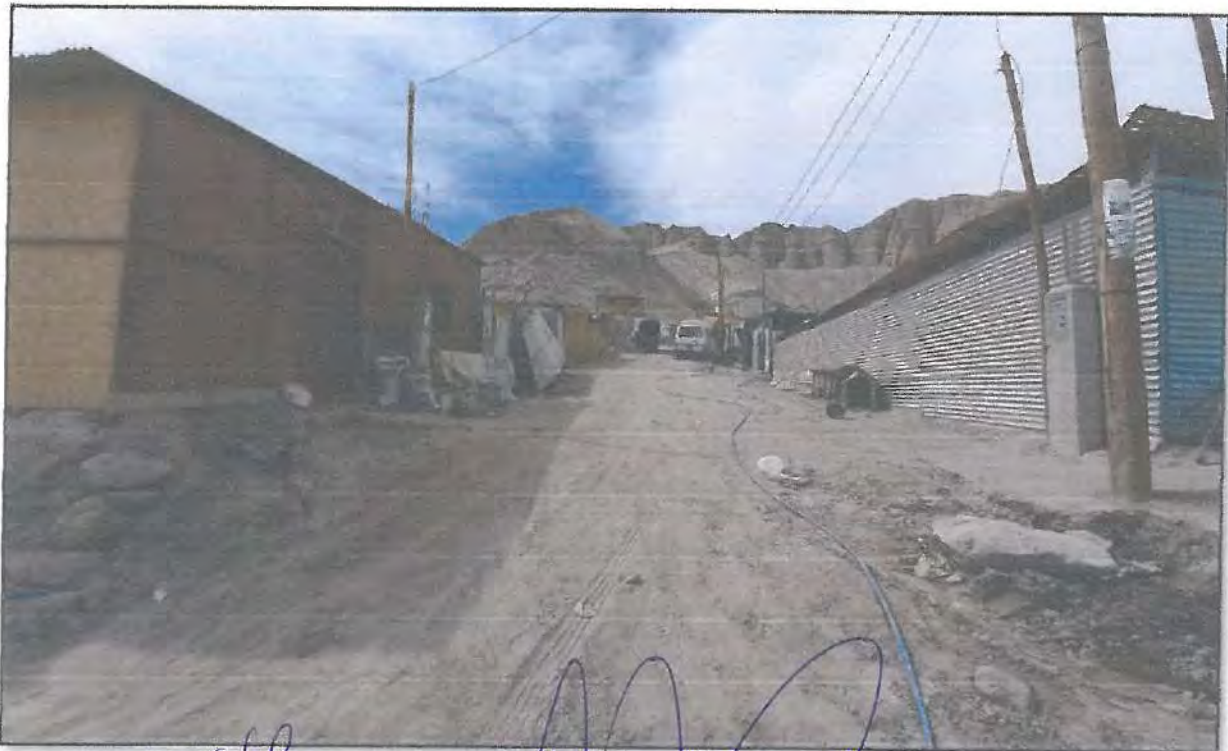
Vista de Calle N° 02 entre la manzana F y G
